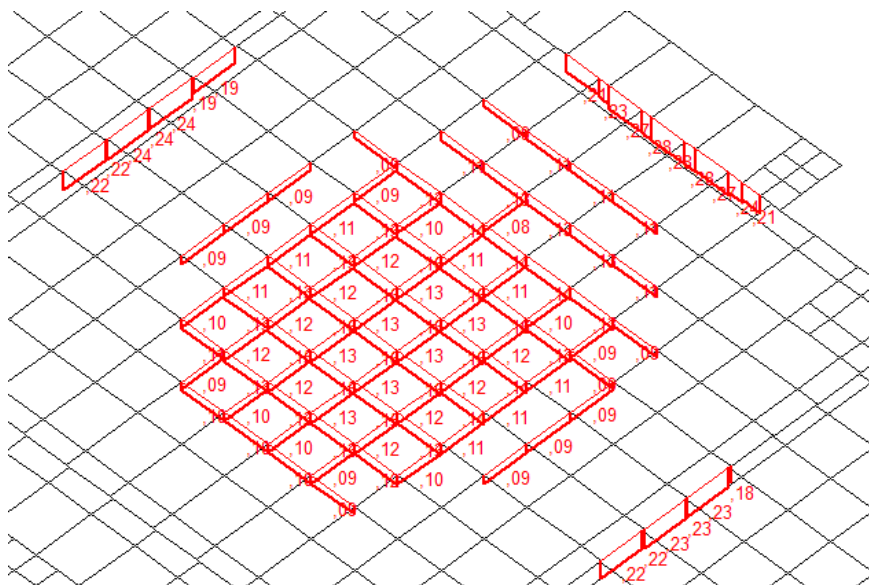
Ampliação da abertura de fissuras no pavimento PT1 da Solução de Laje Nervurada com abertura máxima de 0,28 mm
